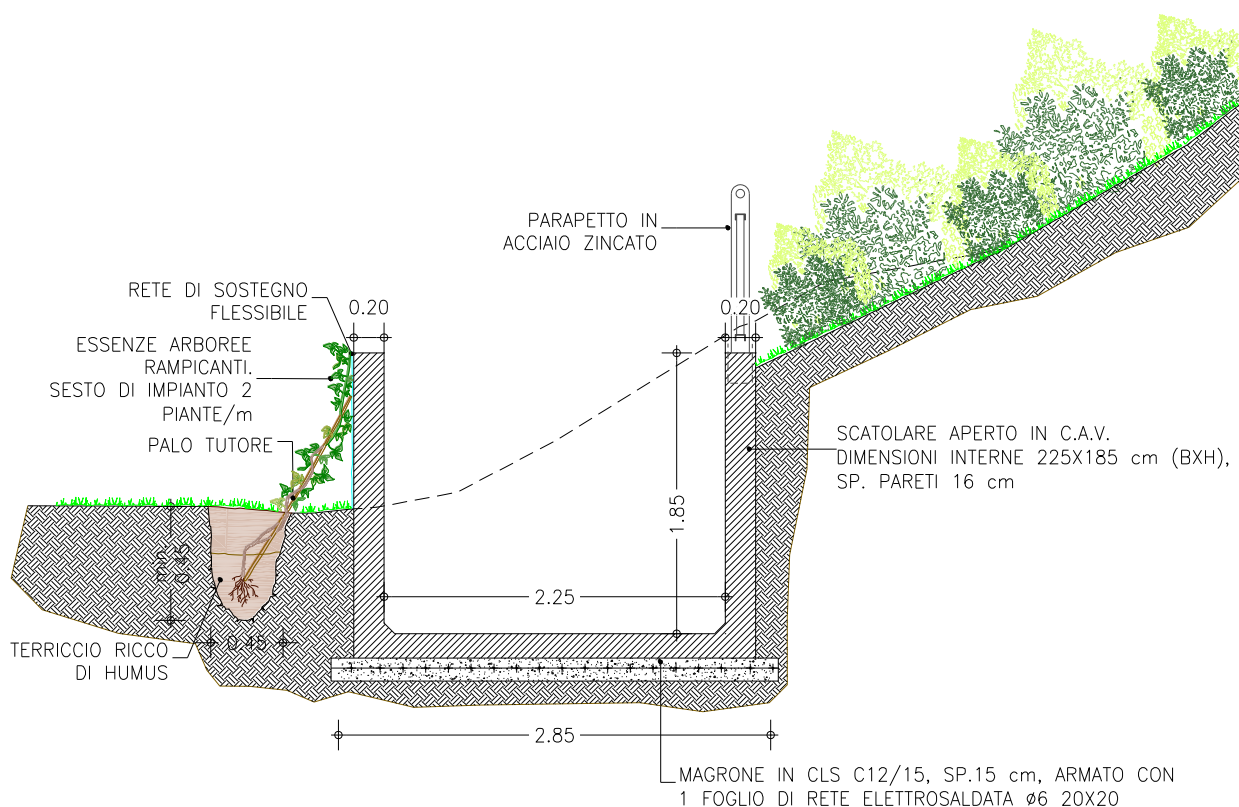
sezione scatolare aperta in C.A.V. all'interno del Villaggio Amaranato. Estratto elaborato T-05.
